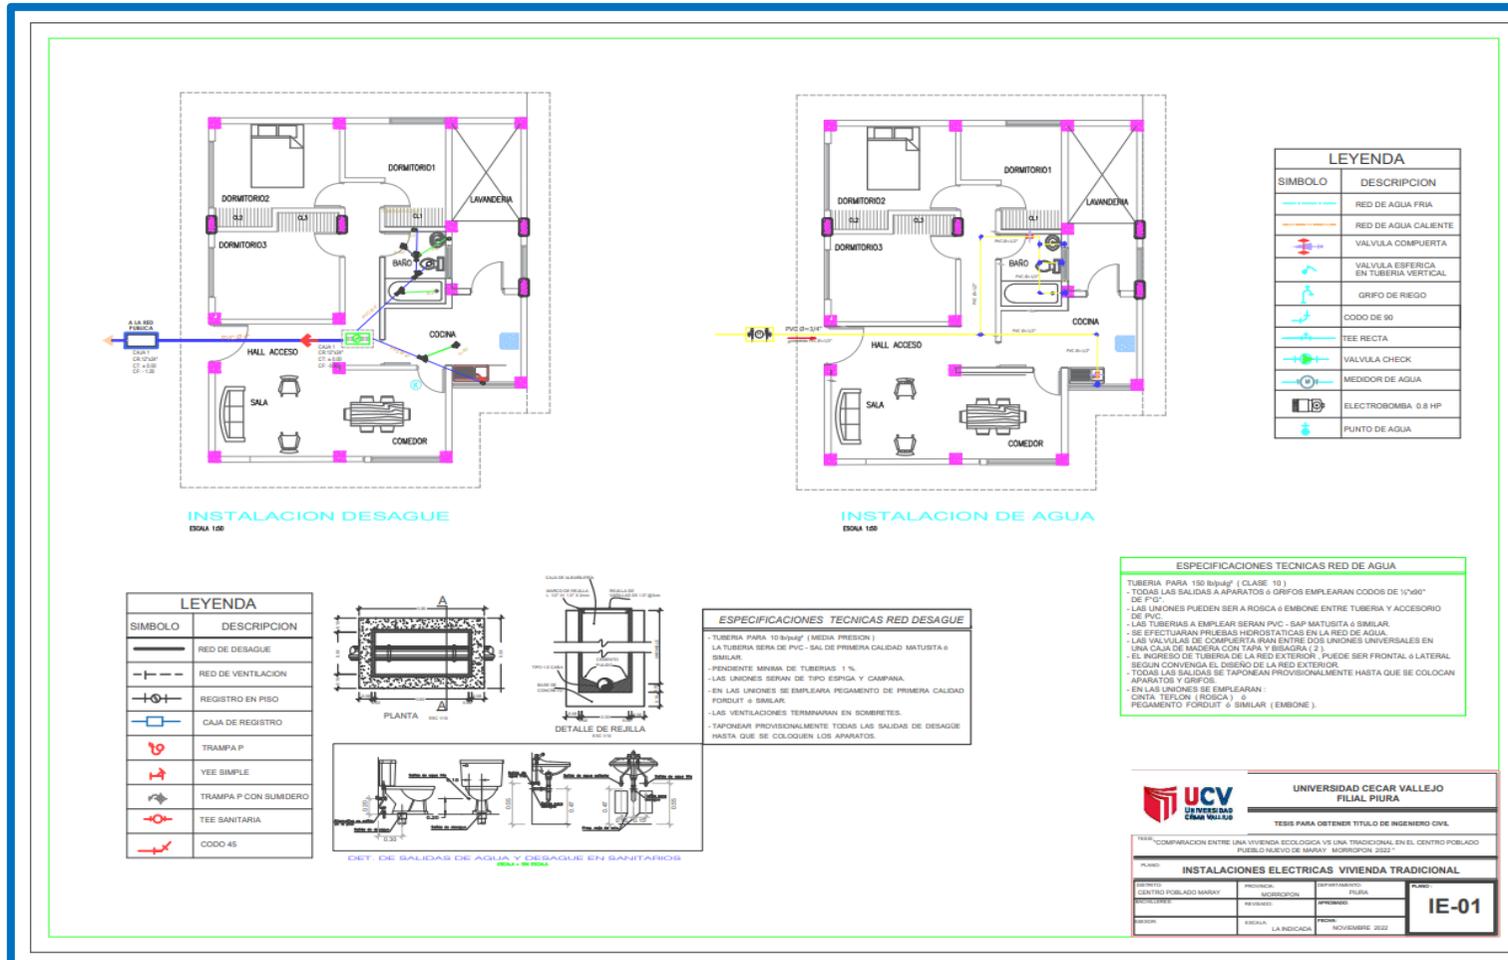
Plano de instalaciones sanitarias – vivienda tradicional (IE – 02)
